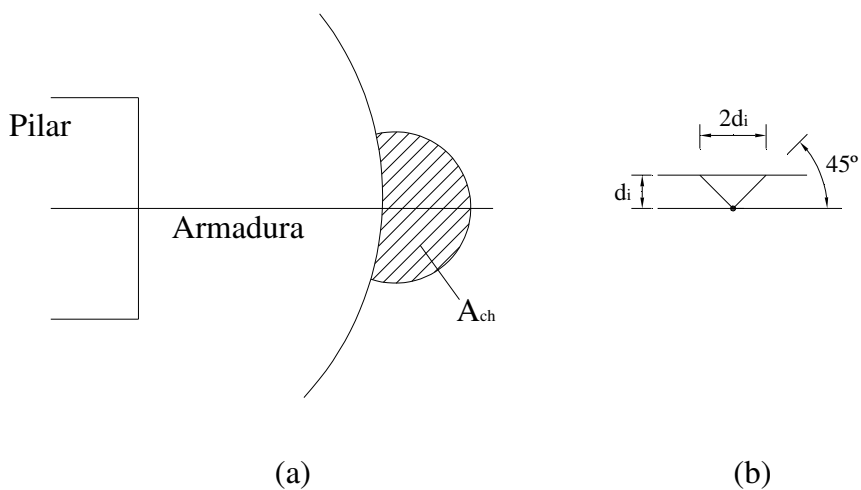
Área de concreto (A_{ch}) envolvida no ponto de encontro armadura / laje ainda intacta (Melo, 1990)
